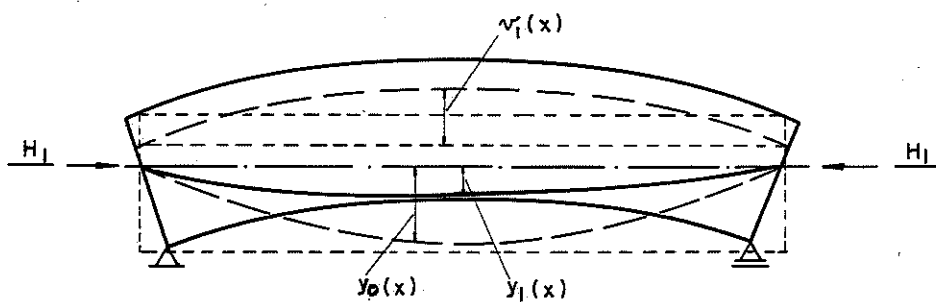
FASE 1 - PROTENSÃO NO CANTEIRO
